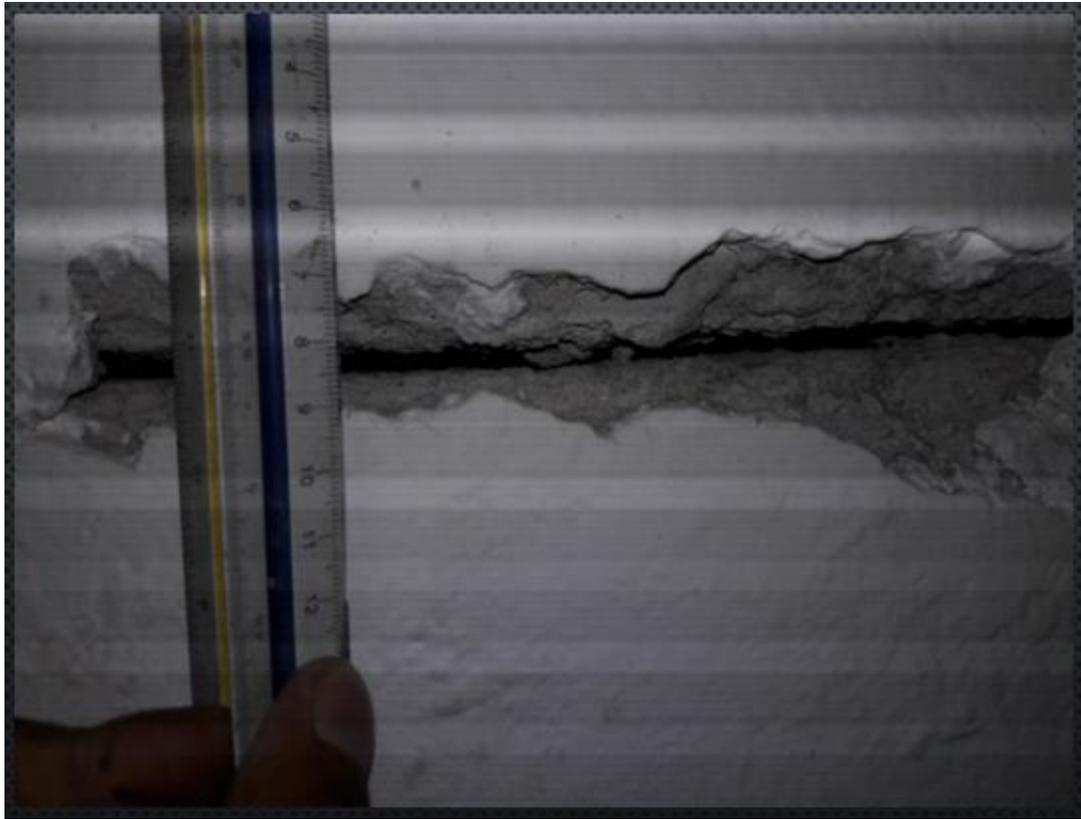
Grieta muro de segundo nivel entre eje 2 y 3 del eje C
